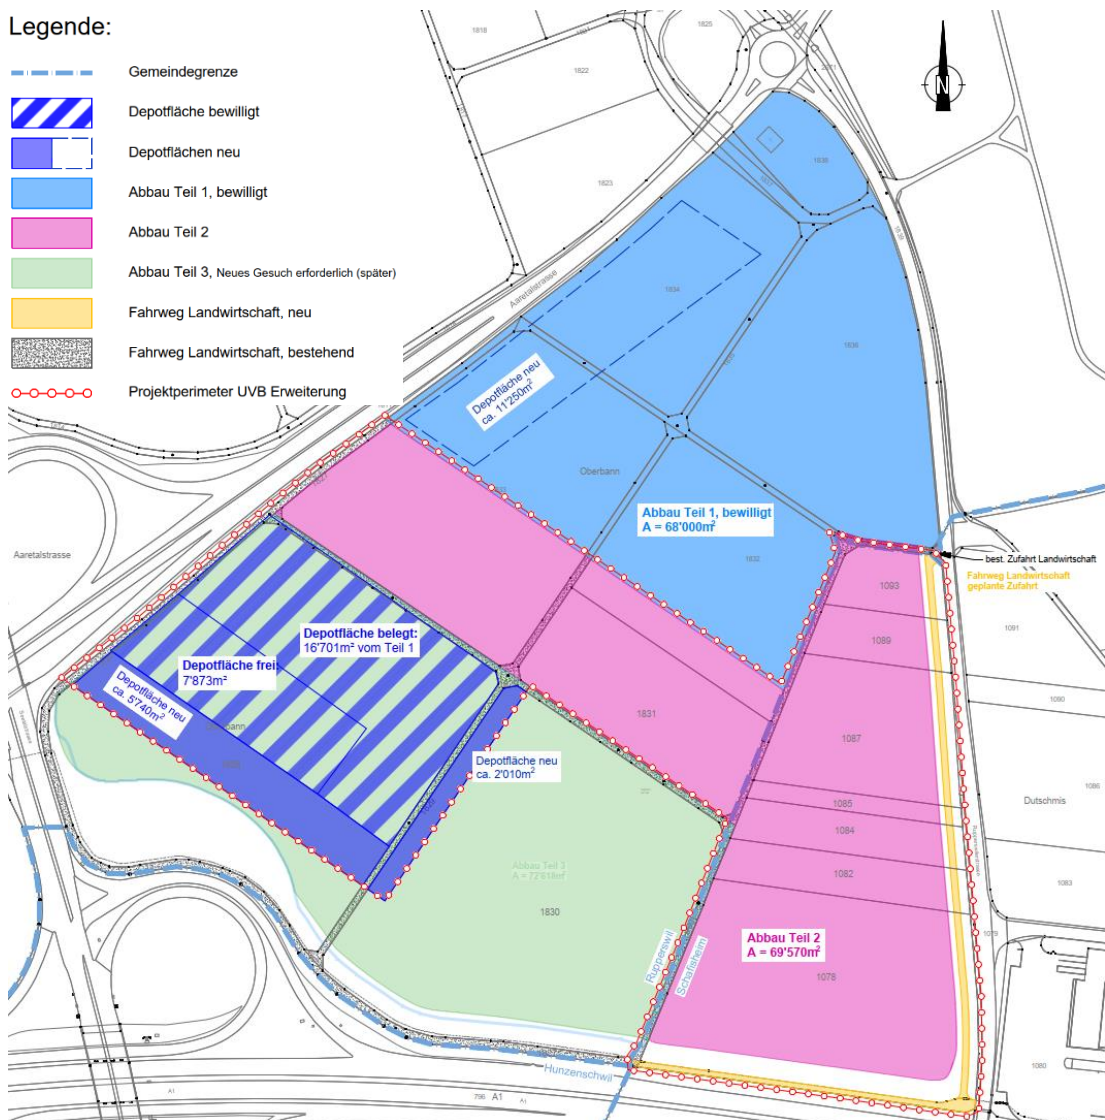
Ausschnitt Situationsplan Abbau (Porta AG, 16.07.2026)
